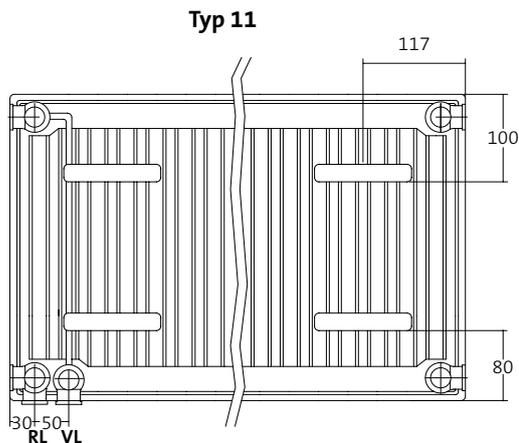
Laschenmaße für Plan Ventil Compact Typ 11 und Ramo Ventil Compact Typ 11 mit Befestigungslaschen (Rückansicht)
